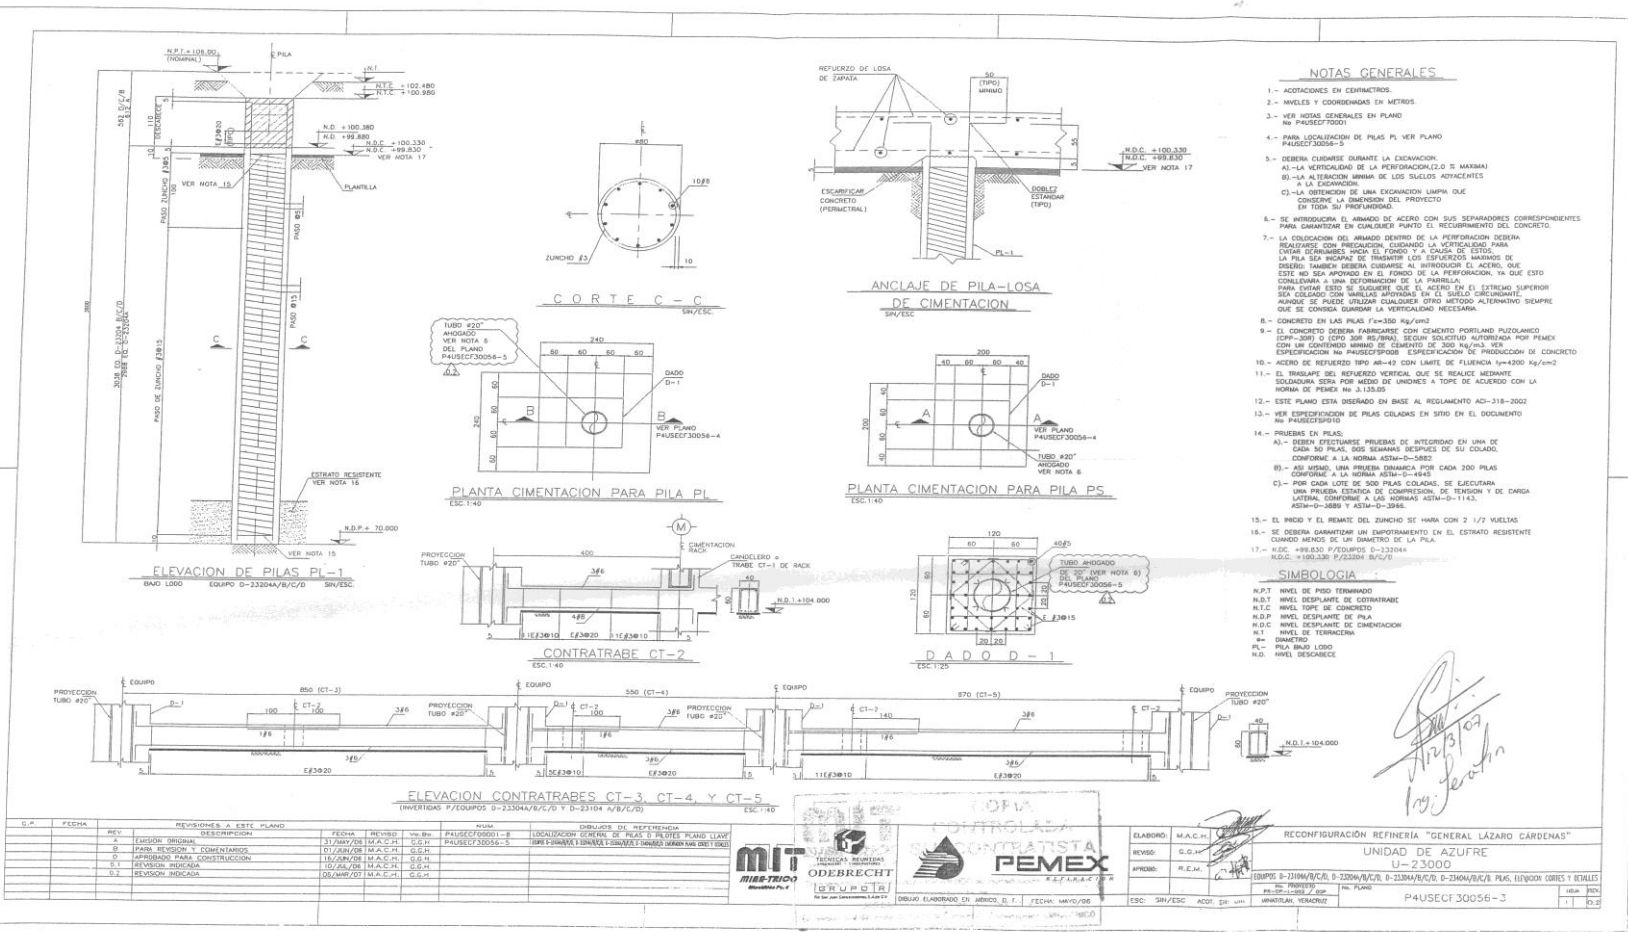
Plano de armado de pila de cimentación del rack secundario.
